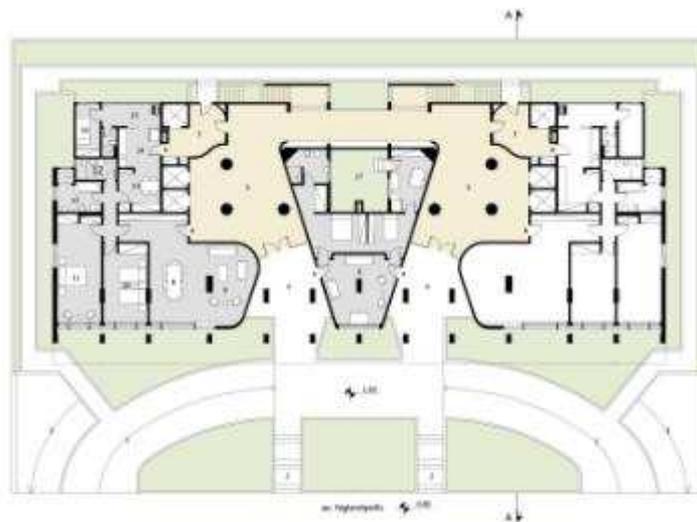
Planta do térreo do Ed. Lausanne (desenho do autor)
